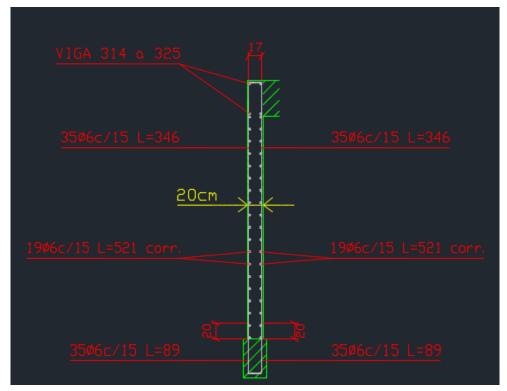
Detalle de tabiques de hormigón – proyecto parque este
